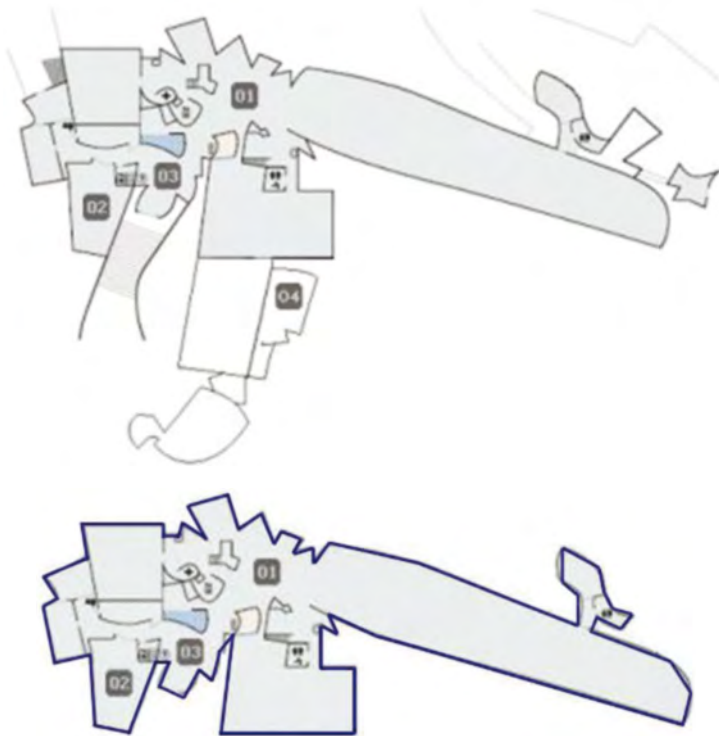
Plano de la primera planta del museo Guggenheim de Bilbao (fuente: <http://www.guggenheim-bilbao.es/>) y su modelización mediante un polígono (paso 1).
